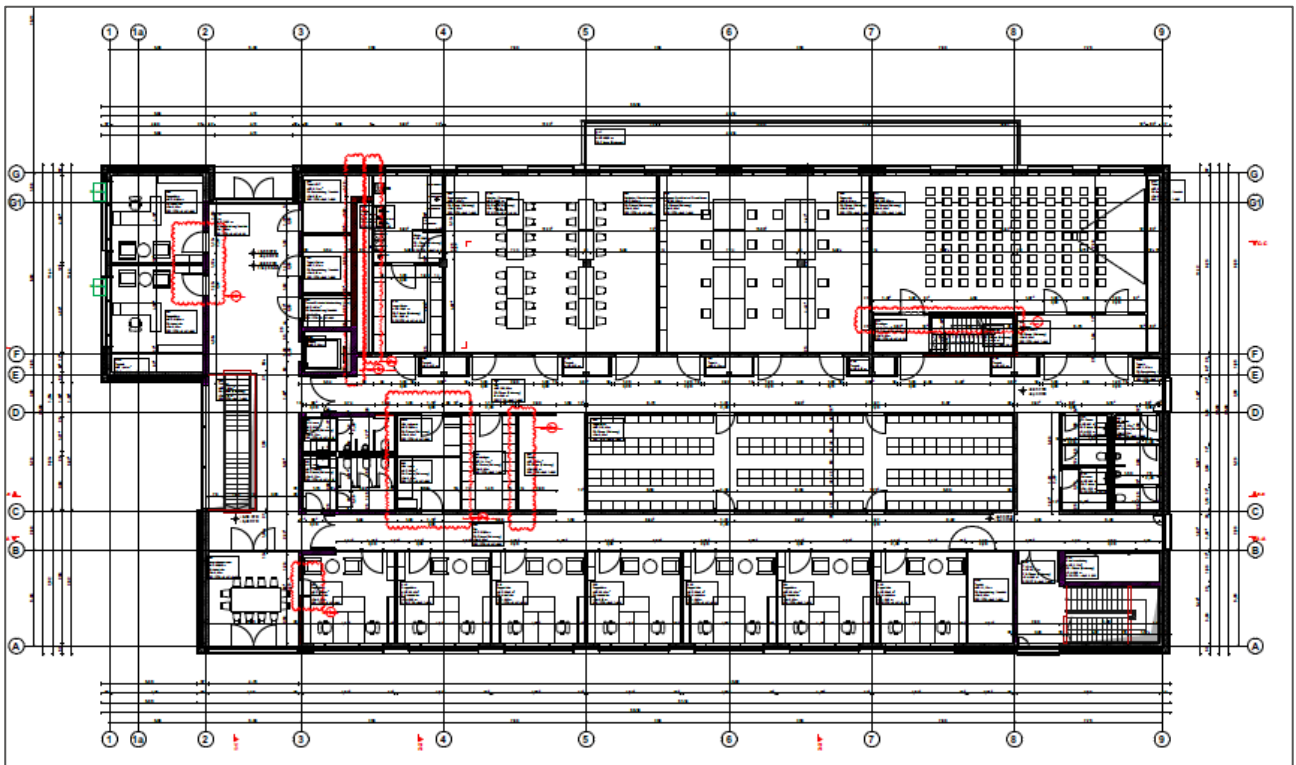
Labor- und Verwaltungsgebäude, Planauszug Grundriss 2. Obergeschoss
